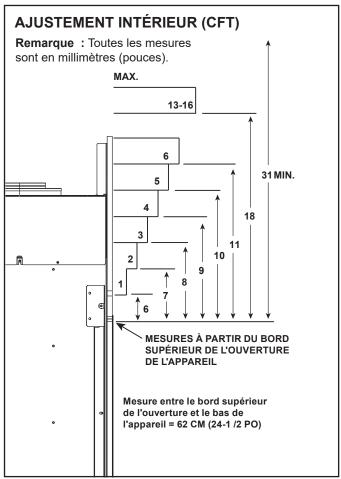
Dimensions des matériaux non combustibles minimaux verticaux et maximaux horizontaux -Finition par ajustement intérieur
